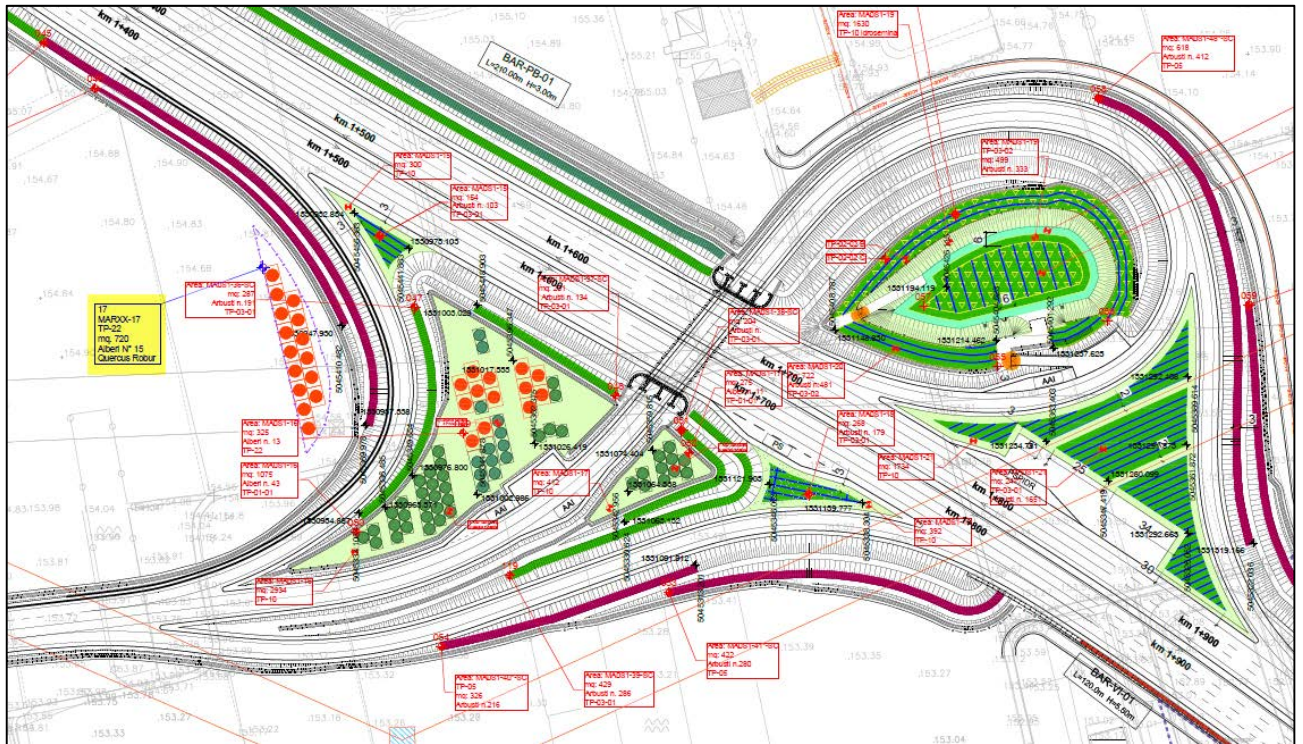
Stralcio planimetrico filari - evidenziata area d'intervento – MARXX-17
